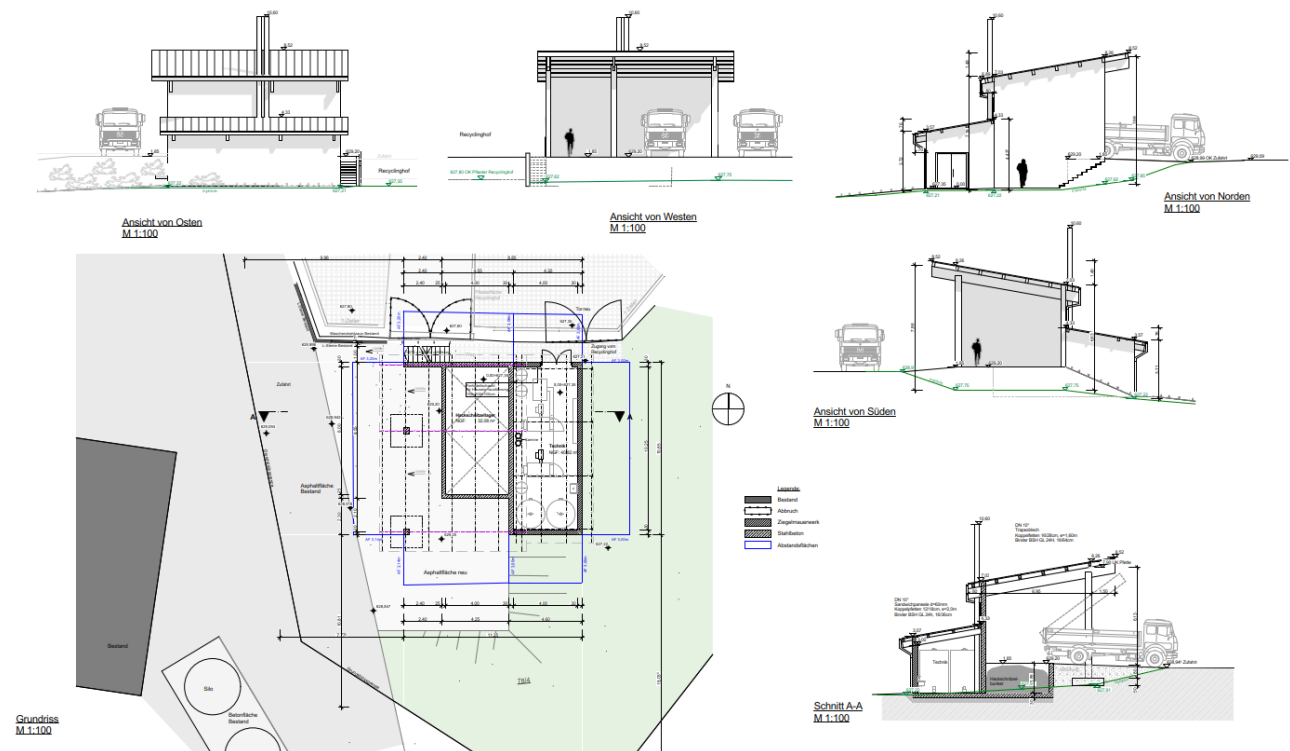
Grundriss, Schnitt und Ansichten
